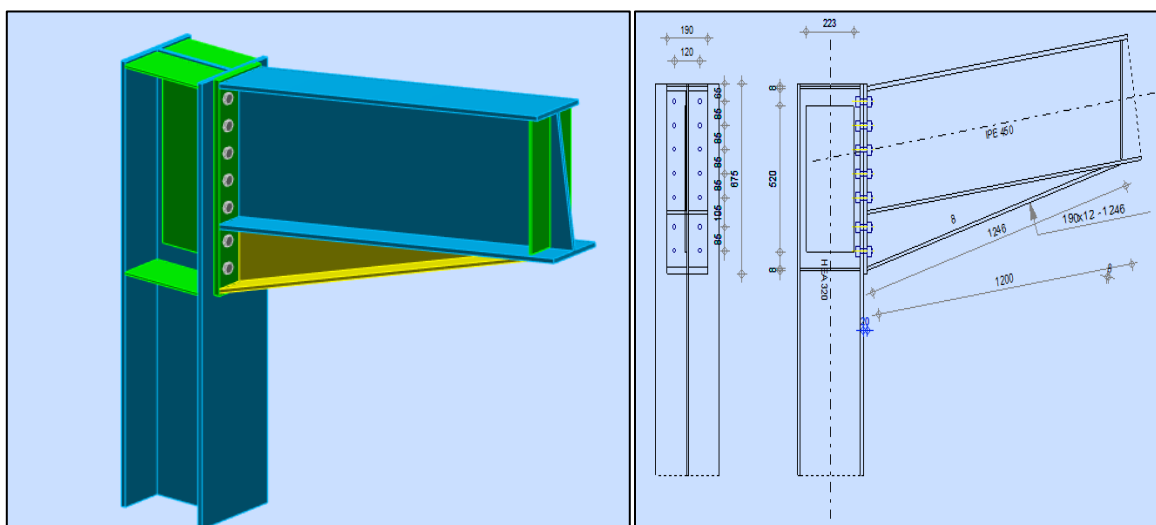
Représentation de l'assemblage Poteau–Traverse
